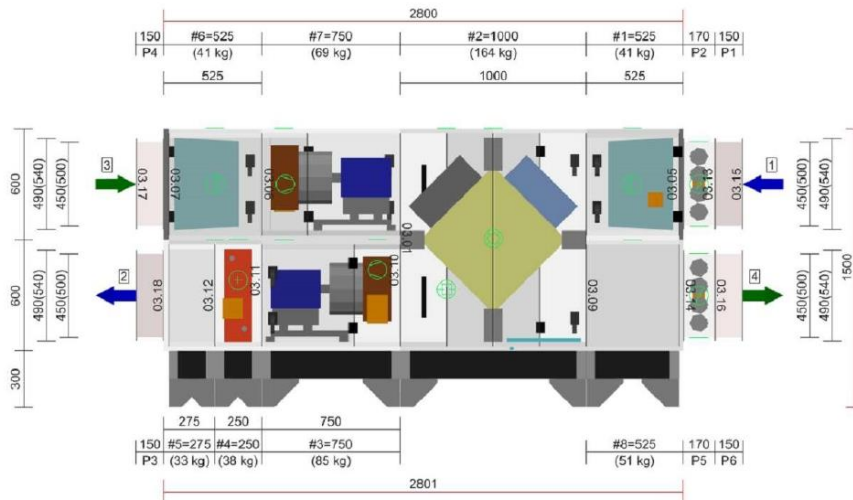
Vzduchotechnické zařízení č. 3 – specifikace
